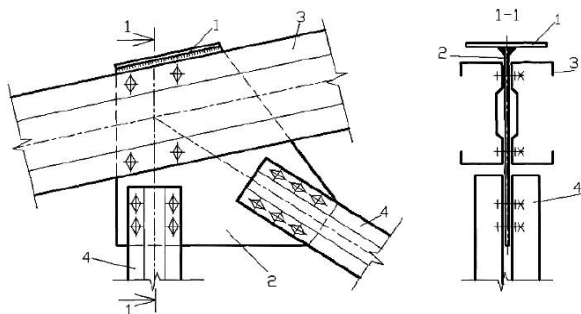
Конструкция фасоночного узла фермы с креплением на болтах: 1 – горизонтальная пластина; 2 – вертикальная пластина; 3, 4 – С-образные профили
